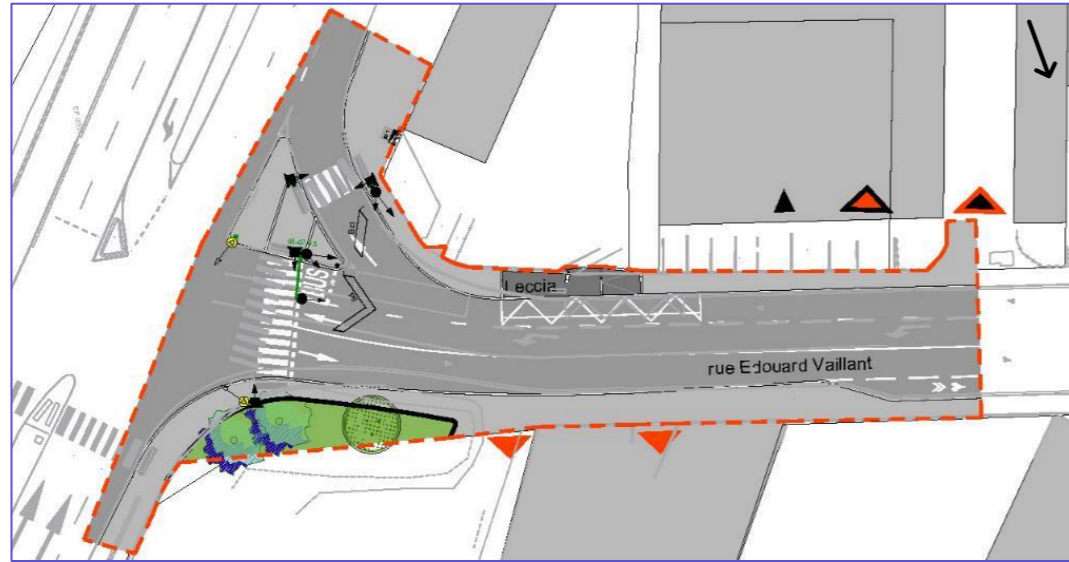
PLAN PROJET – STATION LECCIA EST
